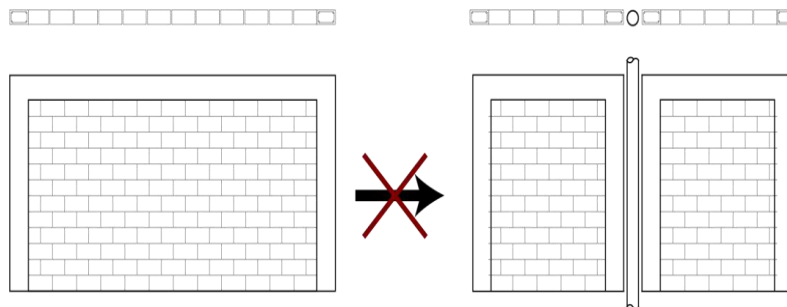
División de muros en obra para acomodar tubería, no considerada en el proyecto estructural.
